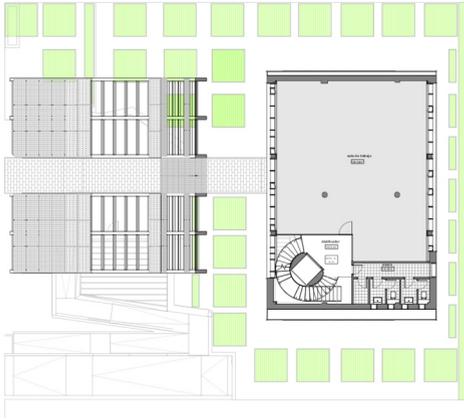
Plano de planta tipo de oficinas. Figura 13. Acondicionamiento interior, aislamiento acústico e iluminación natural y led.
